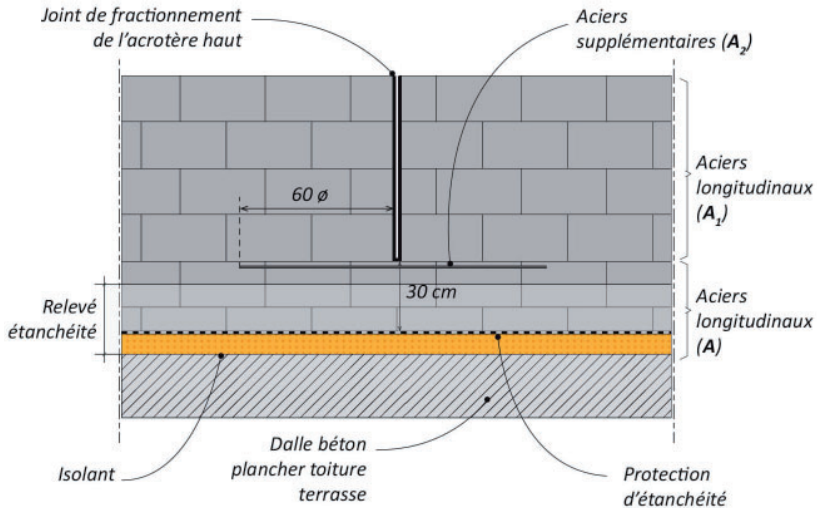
Dispositions au droit des joints transversaux et horizontaux
